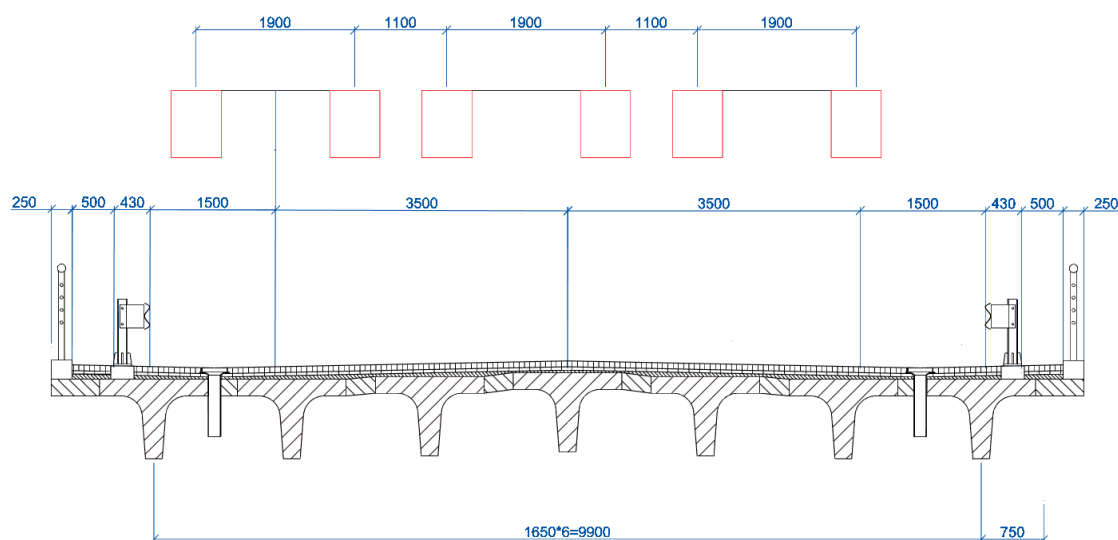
Наиболее невыгодное расположение проектной нагрузки АК (разработан авторами)
